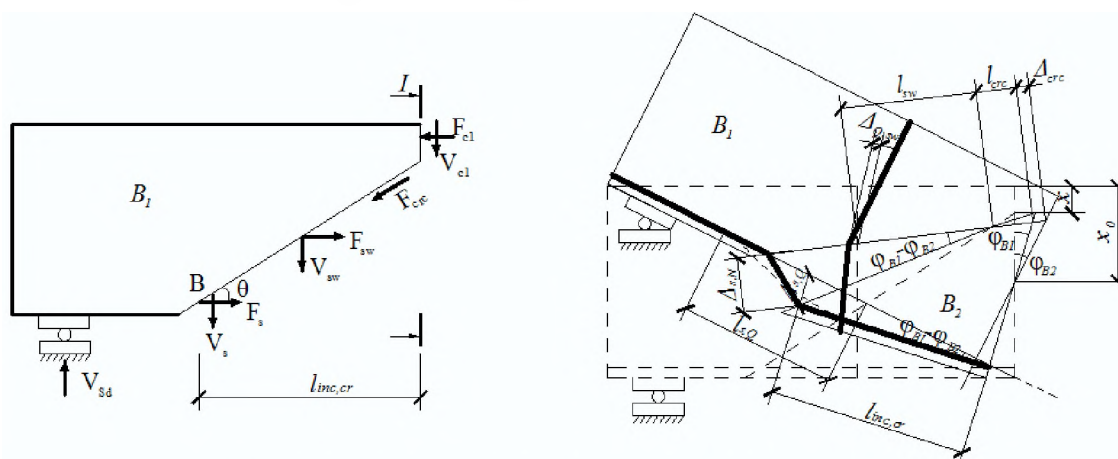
Железобетонная конструкция с «зубчатыми» элементами [1]
